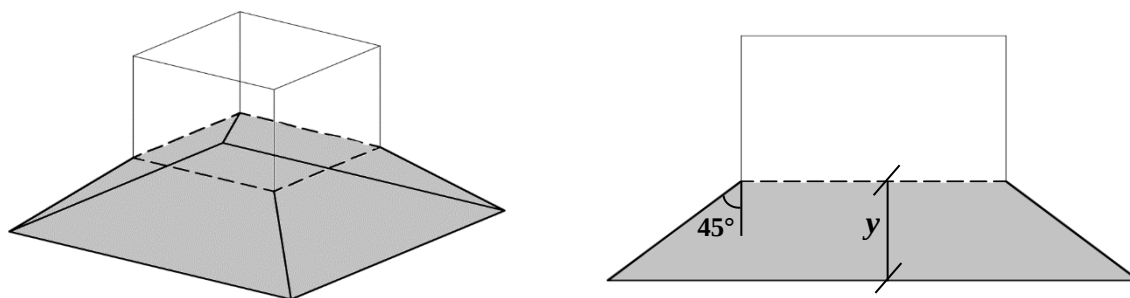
Vista tridimensional e elevação da região nodal expandida abaixo do pilar
